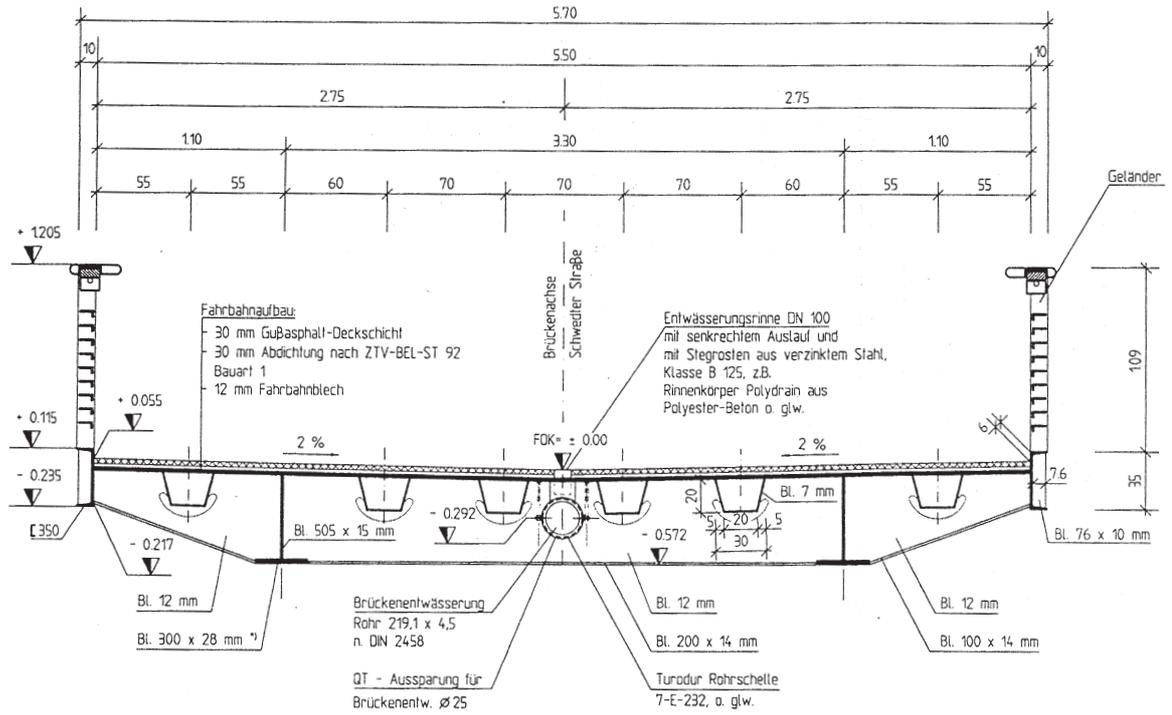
Schwedter Steg Berlin - Querschnitt des 10-feldrigen Durchlaufträgers
